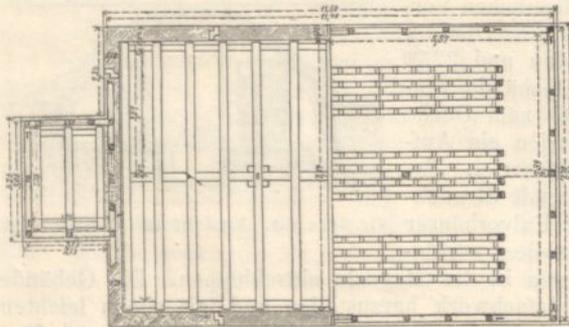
Grundriss des Pulver-Magazins.
